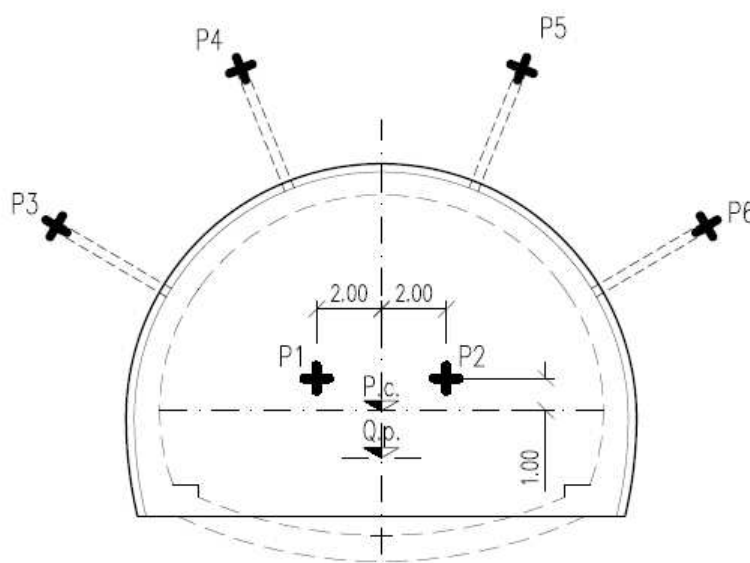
Perforazioni in avanzamento. Schema in sezione trasversale
